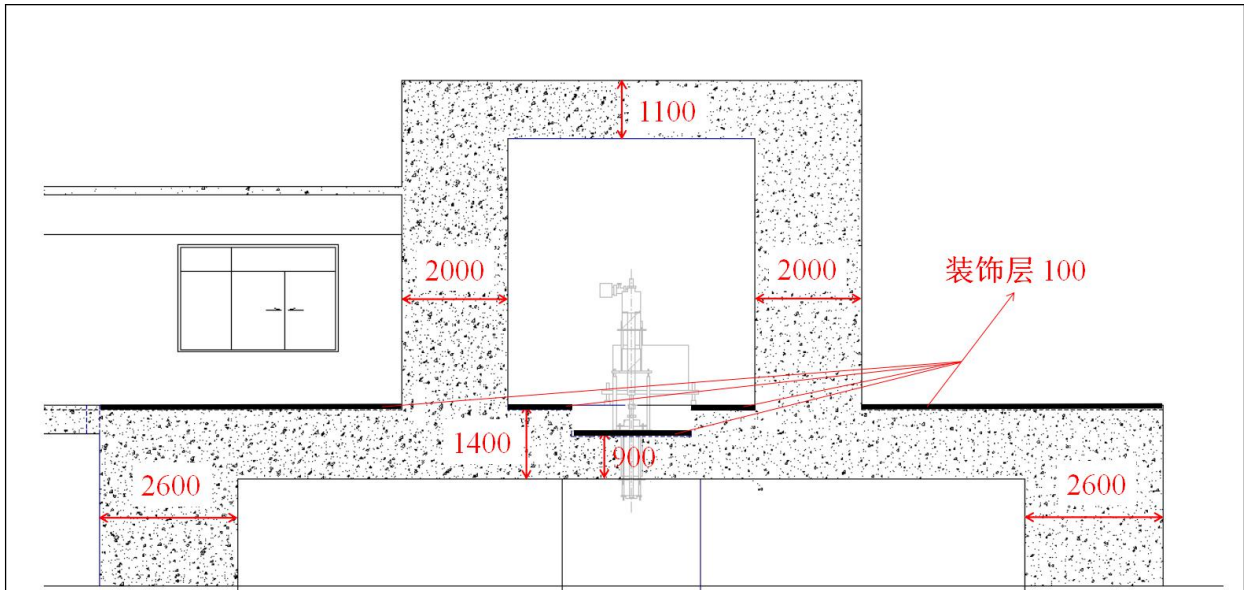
辐照室及主机室墙体屏蔽设计横剖面图
